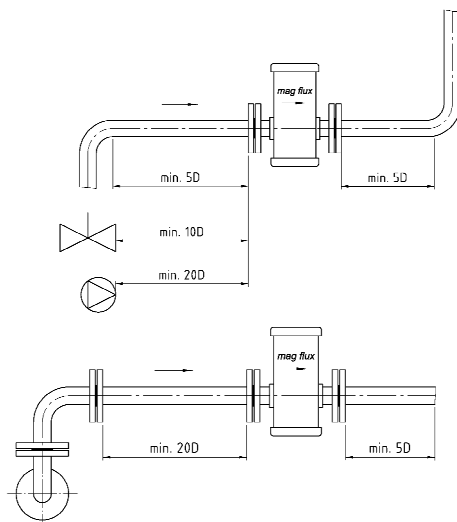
Einbau zwischen Rohrkrümmern, Ventilen und Pumpen
